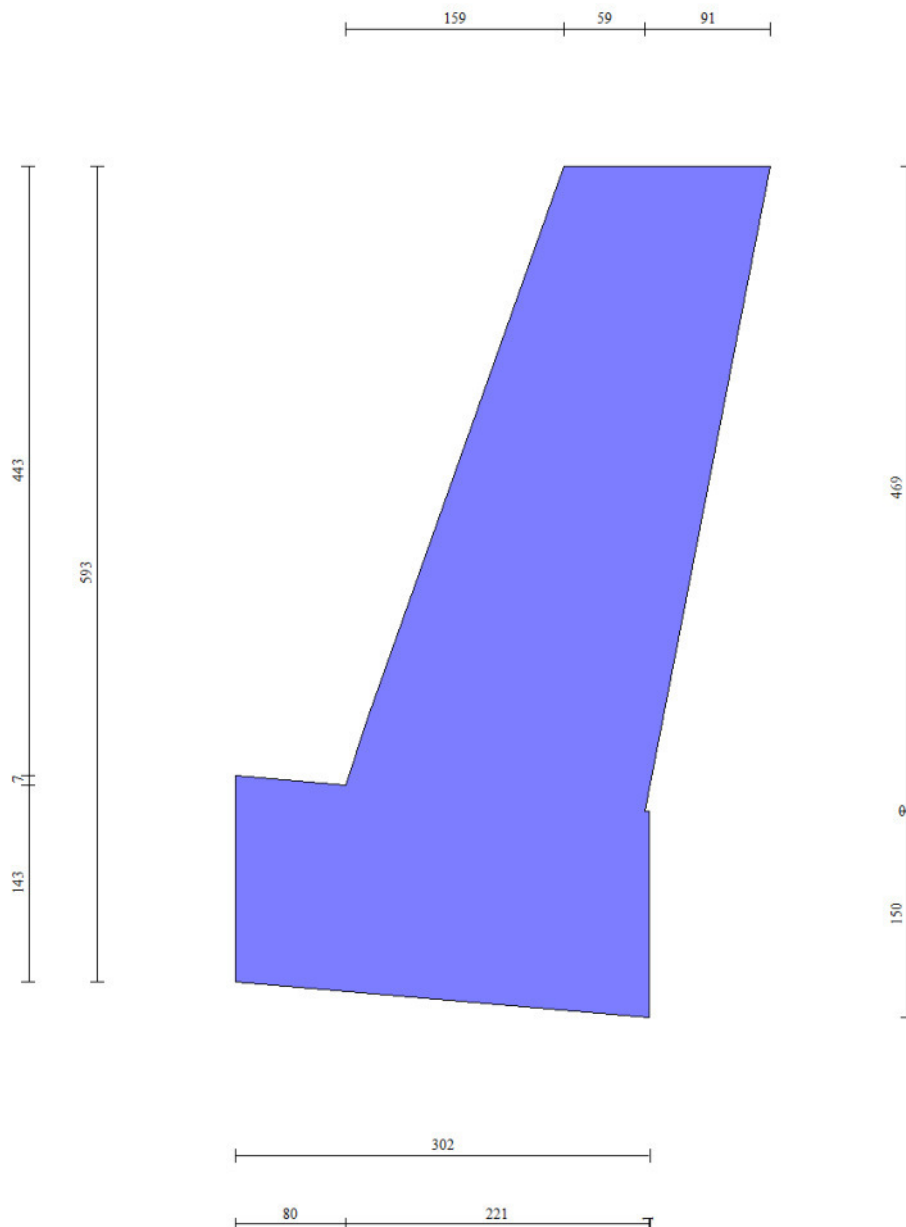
Estratto dal software di calcolo MAX 16.0 – Geometria di modellazione scogliera – intervento 9.
